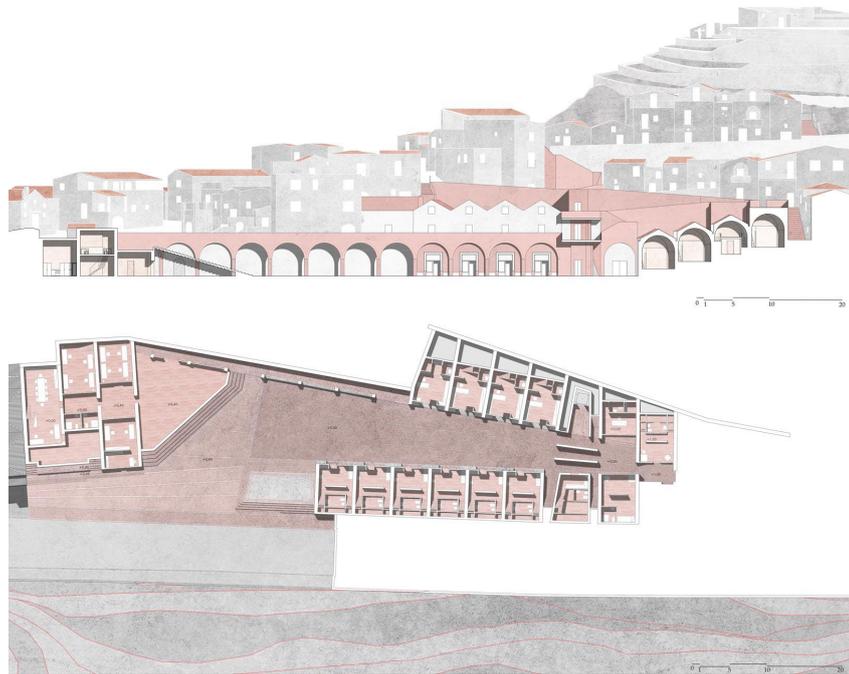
Elaborati progettuali. Dall'alto: sezione longitudinale con individuazione dei laboratori, piazza-mercato, residenze d'artista; planimetria generale di progetto.
